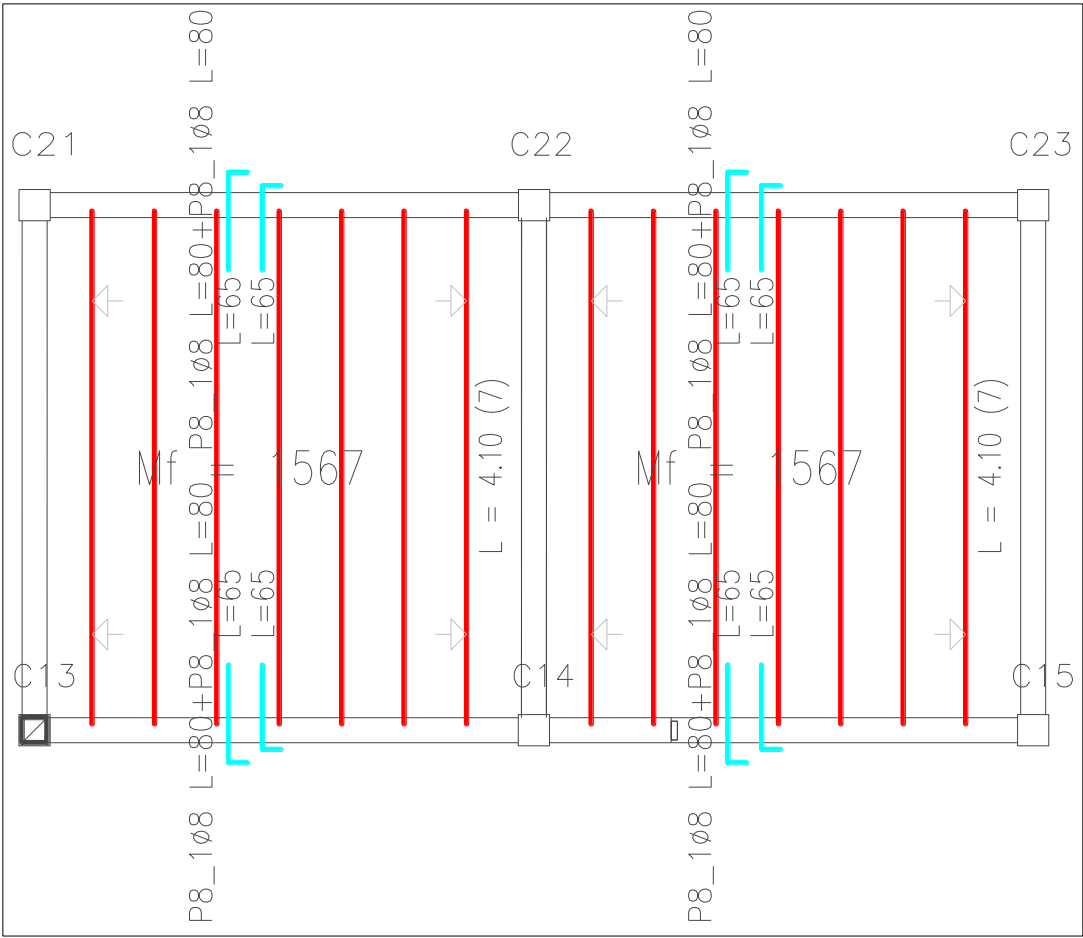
Armado y disposicion de viguetas, Elaboración Propia
